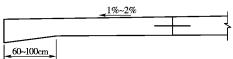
水泥混凝土面层变截式横断面示意图
